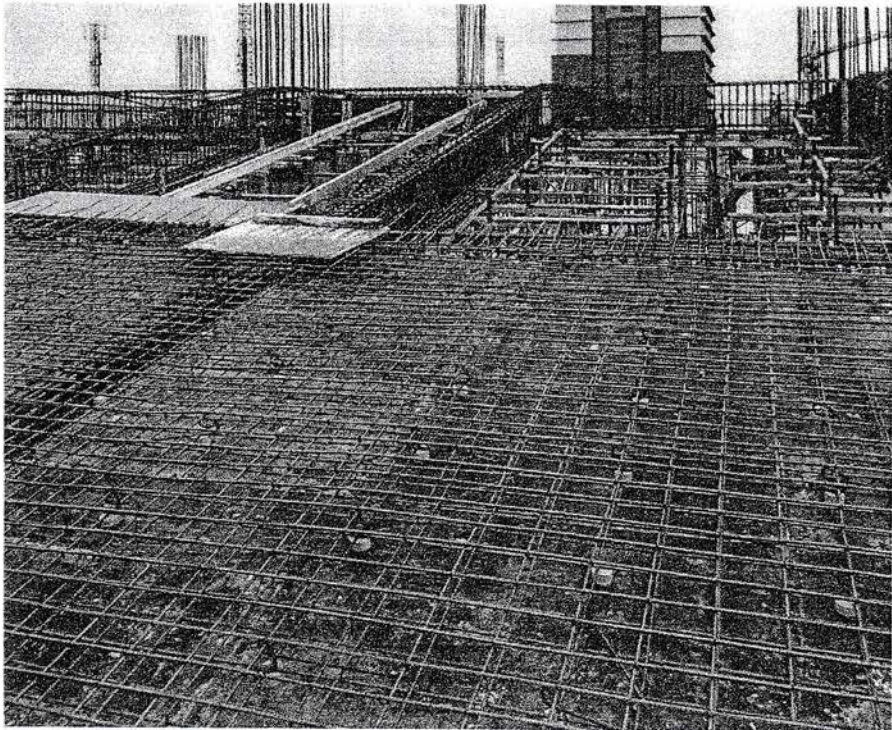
Pemasangan Tulangan dan begel pada balok
